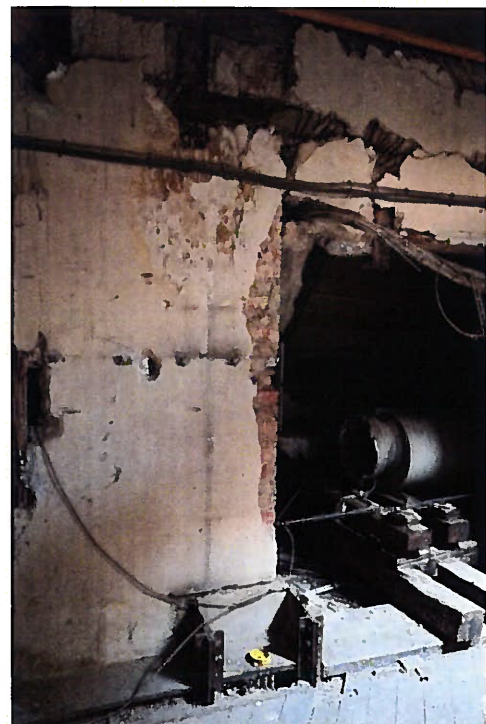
Dachraum Mauritiusstraße, Träger und darüber Reste einer Tragkonstruktion, Sept. 2017
